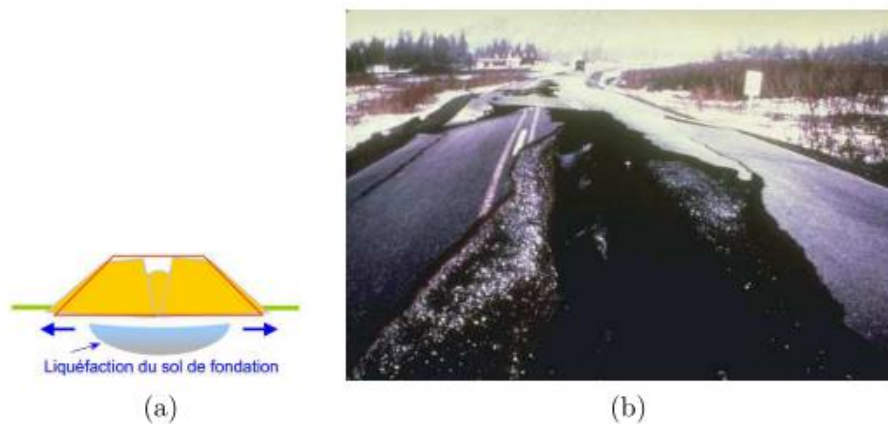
(a) Liquéfaction du sol de fondation ; (b) fissure longitudinale d'un remblai routier après le séisme d'Alaska.
